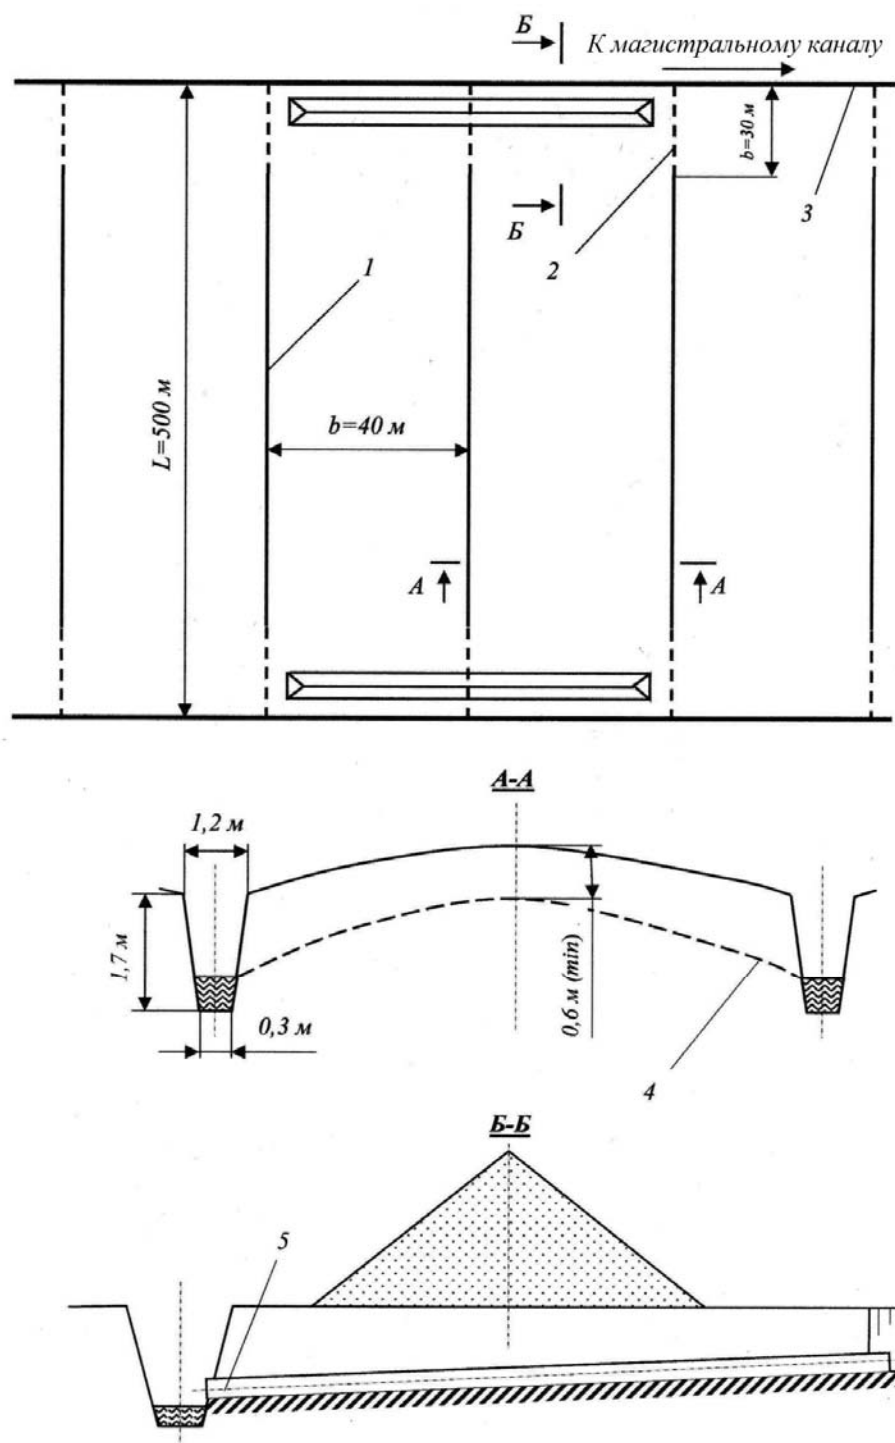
Схема осушительной сети участка добычи торфа фрезерным способом: 1 - картовый канал; 2 - трубчатый переезд; 3 - валовый канал; 4 - депрессионная кривая; 5 - труба
